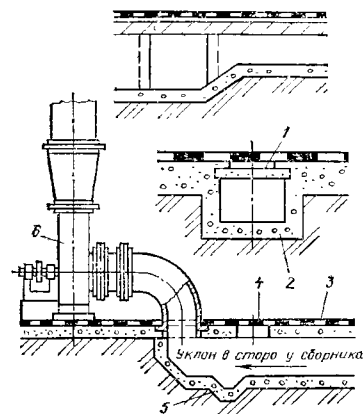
Типовой подпольный канал: 1 — железобетонная плита; 2 — бетон; 3 — металлические плитки; 4 — люк; 5 — сборник; 6 — вентилятор
